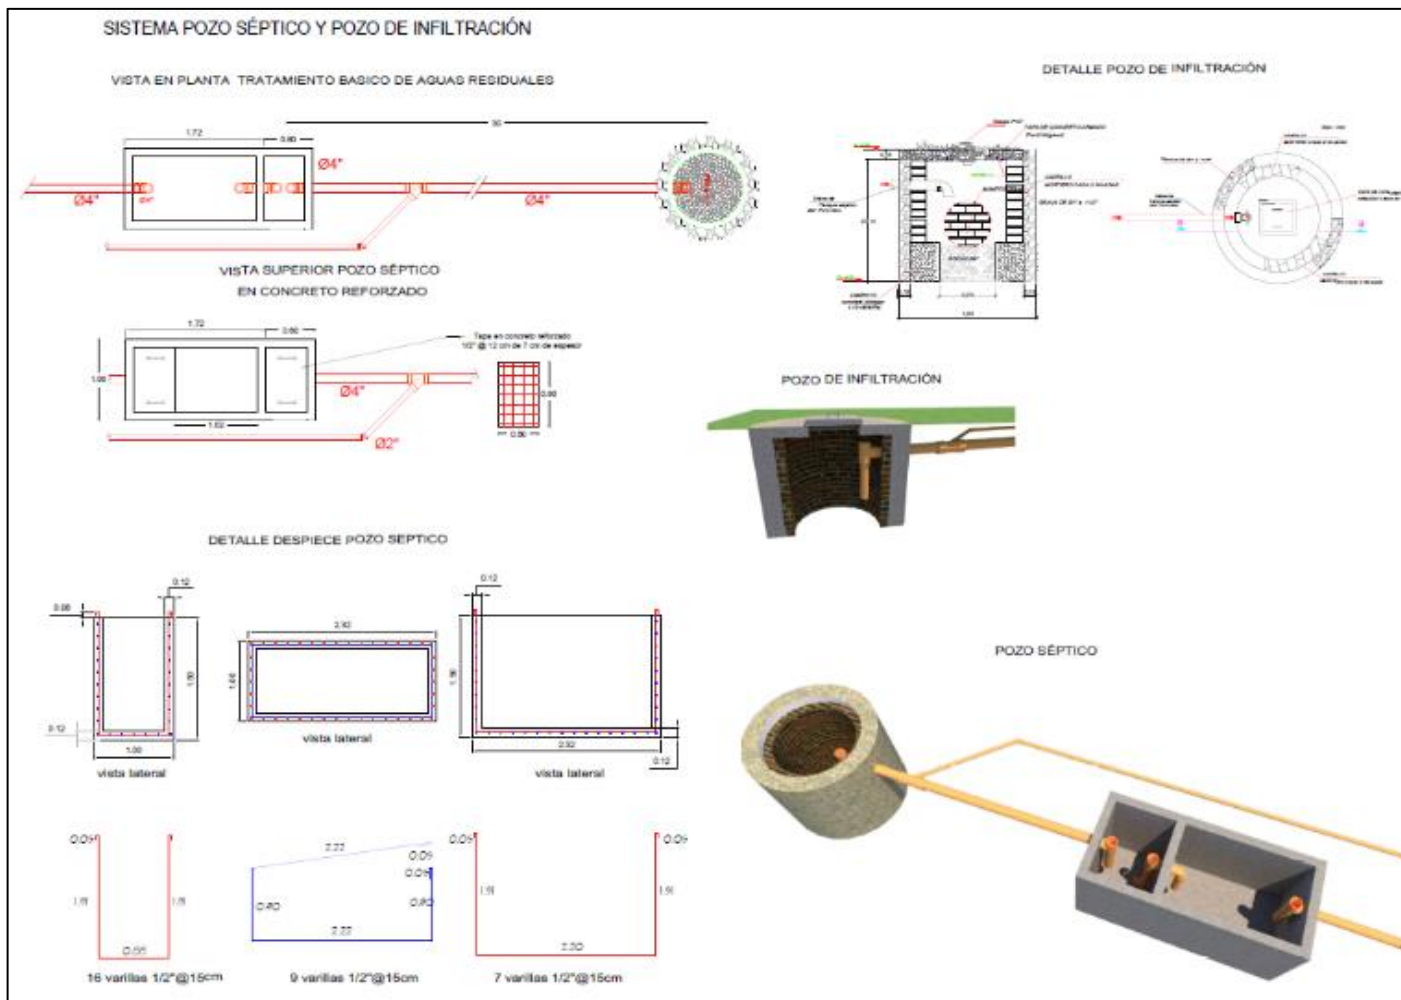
Detalle pozo séptico en concreto y pozo de infiltración.
